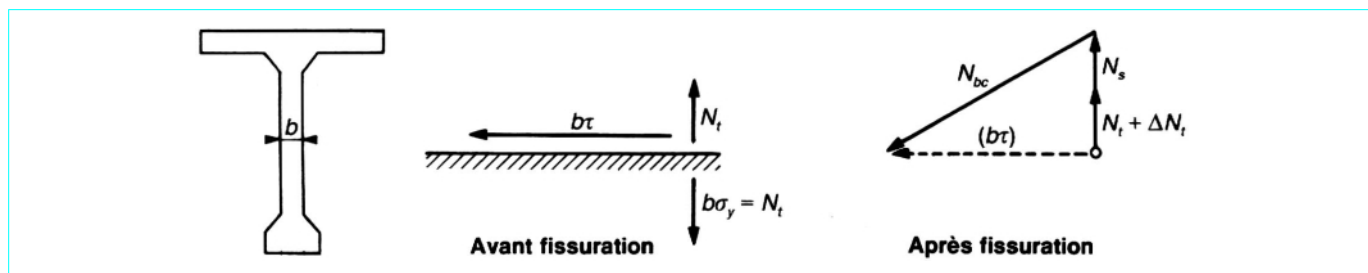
Équivalence des systèmes de forces traversant un élément de plan avant et après fissuration
